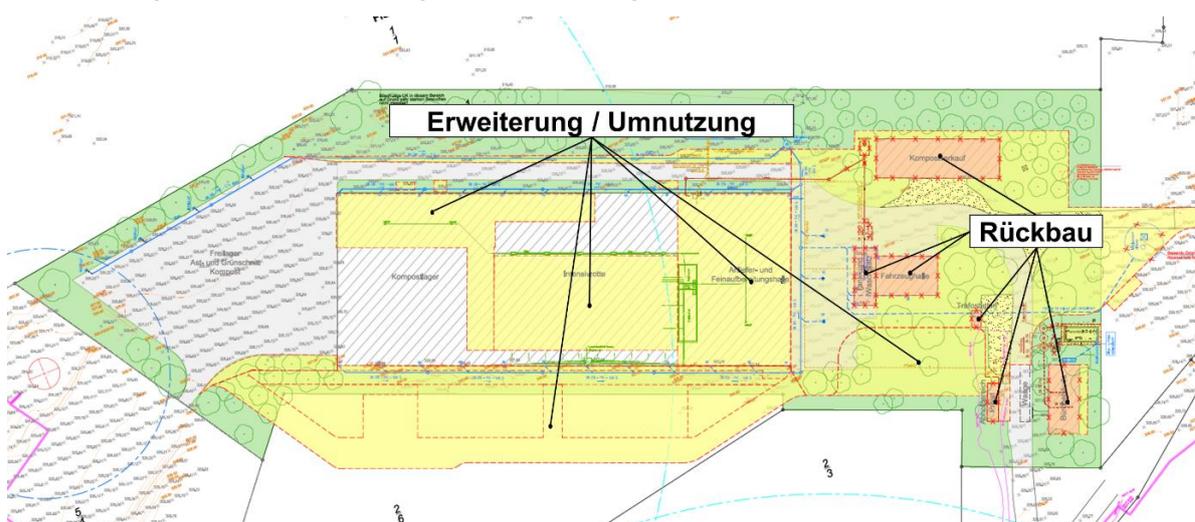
Ausschnitt Lageplan Bestand und Rückbau
